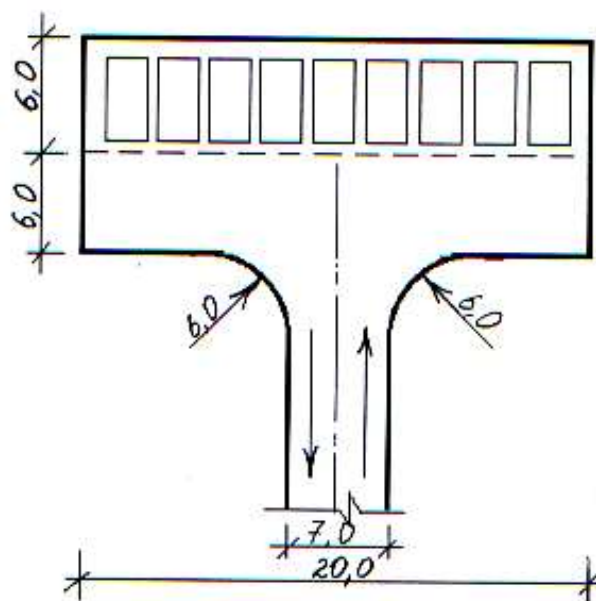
Планировочные схемы поворотных и разворотных площадок на внутриквартальных проездах (окончание)
